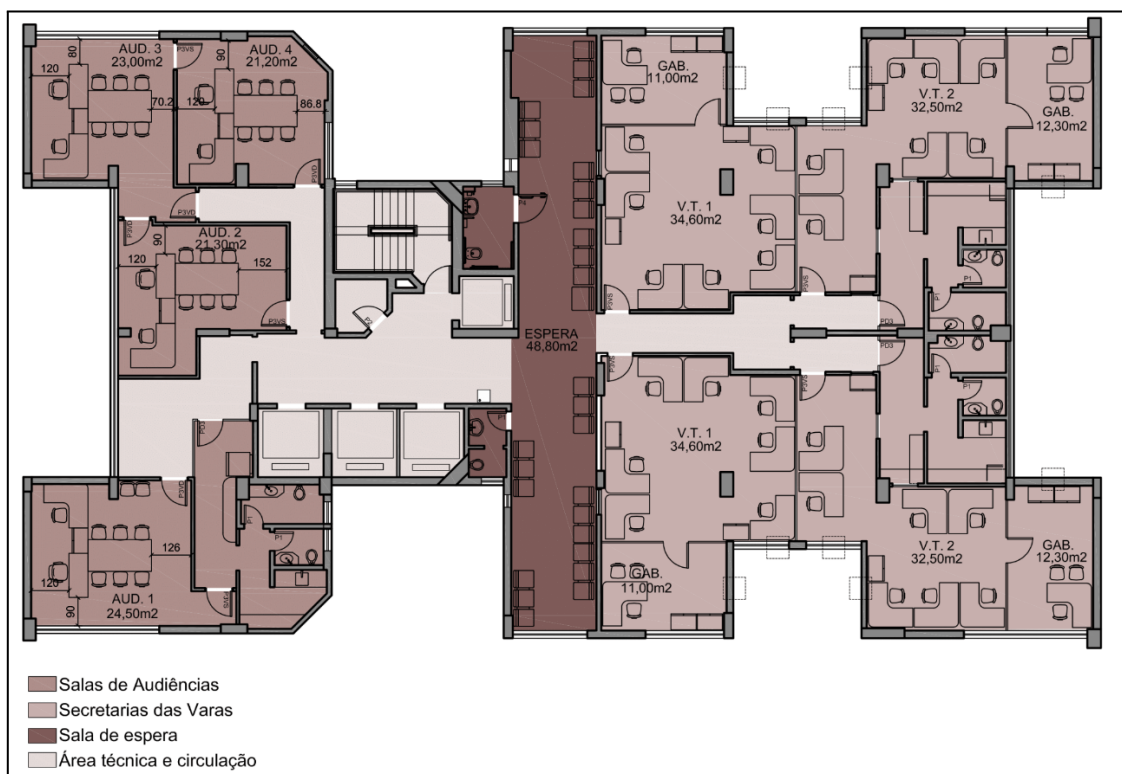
Planta do pavimento tipo atual (com gabinete de juiz).
